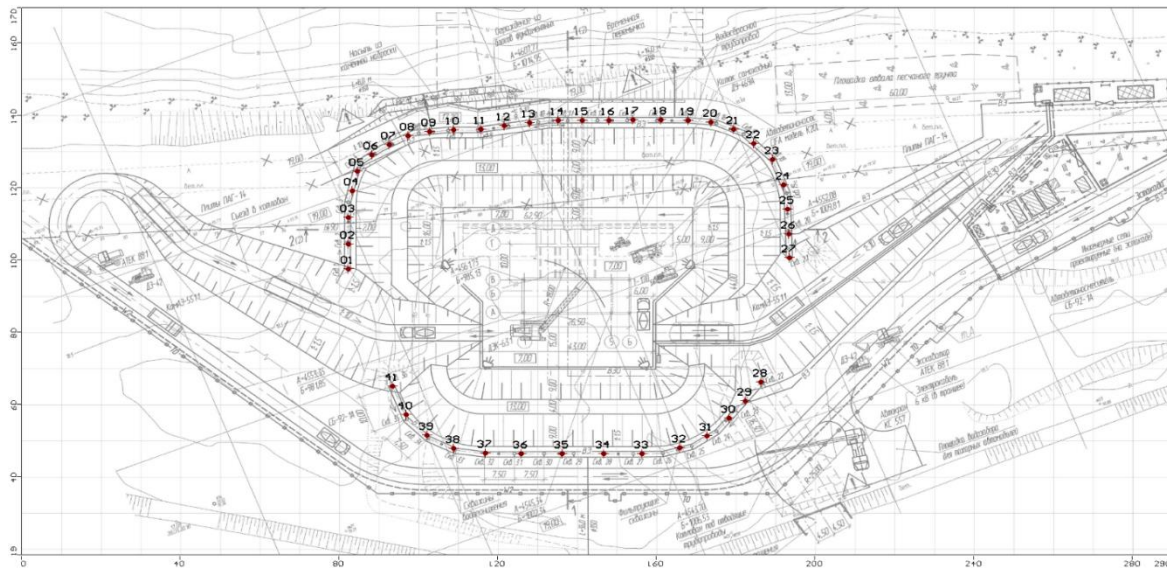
Рекомендована схема розташування водозабірних свердловин на контурі будівельного котловану
